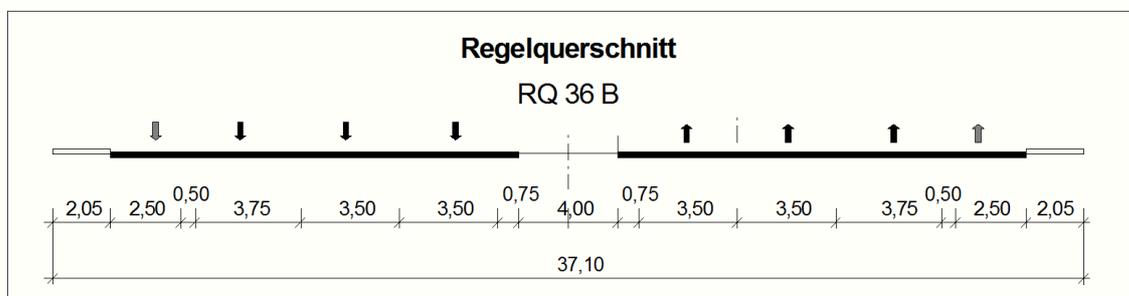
geplanter Brückenregelquerschnitt RQ 36 B
